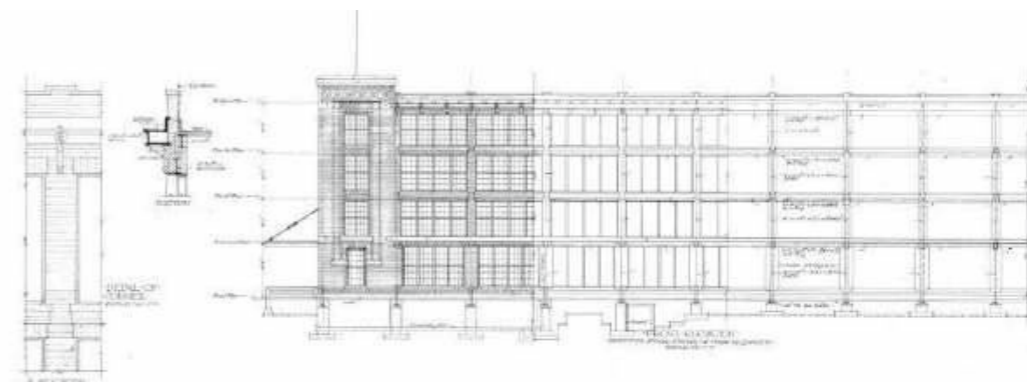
Planskizze der „Highland Park“ Automobilfabrik in Detroit
